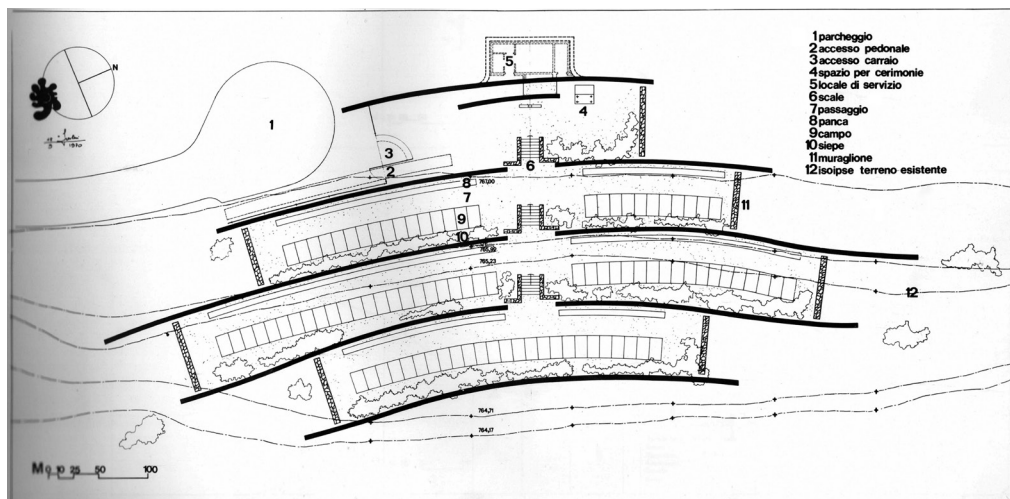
Glauco Gresleri y Silvano Varnier, Cementerio, Erto a Monte (Pordenone), 1970-72; planta (Gresleri 2010).
